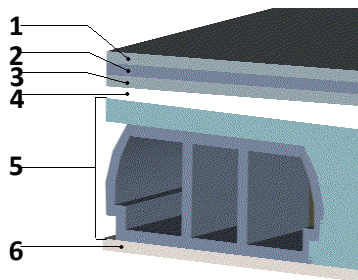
disposition des matériaux pour plancher à corps creux de la terrasse.
